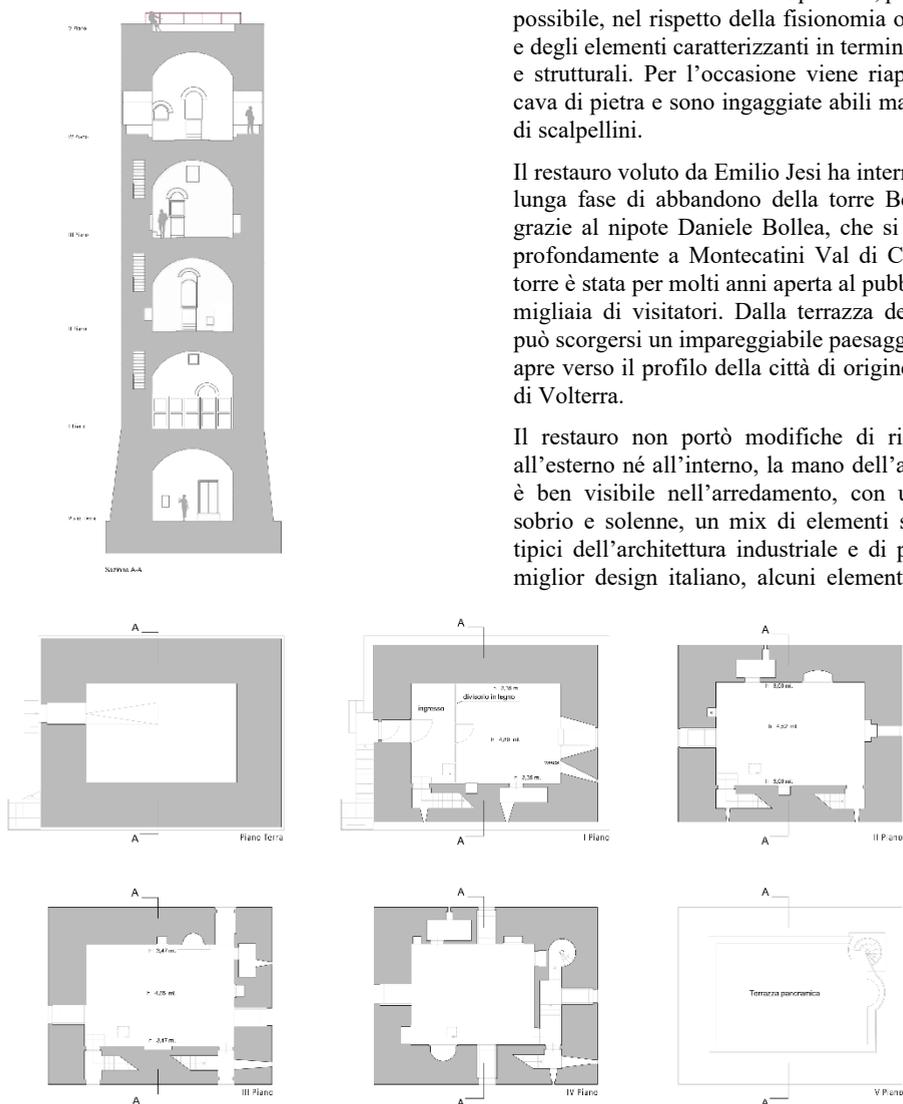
Pianta e sezione A-A Torre dei Belforti
